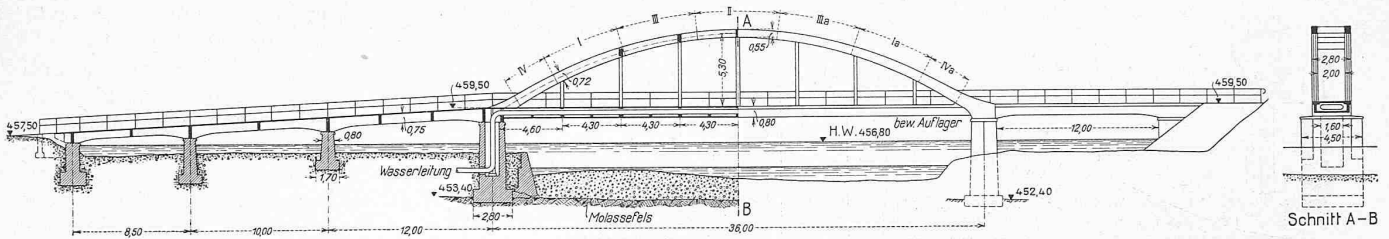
Längs- und Querschnitt und Ansicht der Eisenbeton-Bogenbrücke über die Emme bei Gerlafingen; Gesamtlänge 84 m. — Masstab 1: 500.
